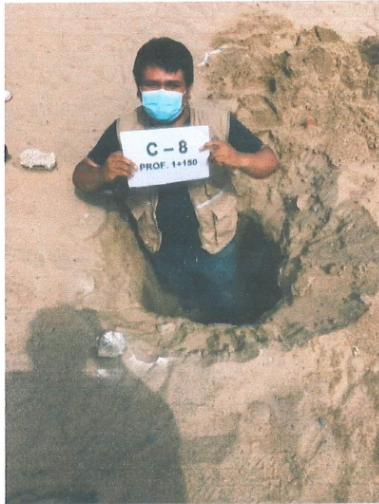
Se aprecia una vista general del lugar donde se excavo la calicata C-08.
